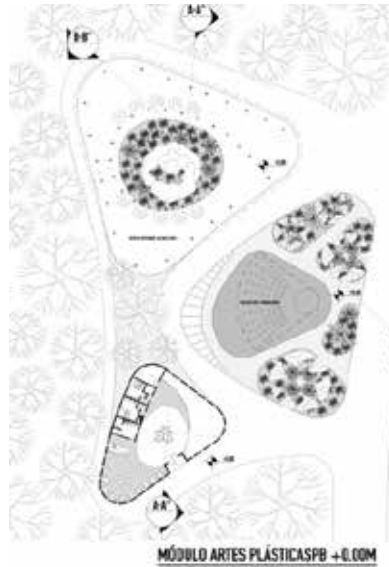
Módulo de Artes Plásticas Planta Baja Nivel +0.00. Fuente Propia. 2017.
